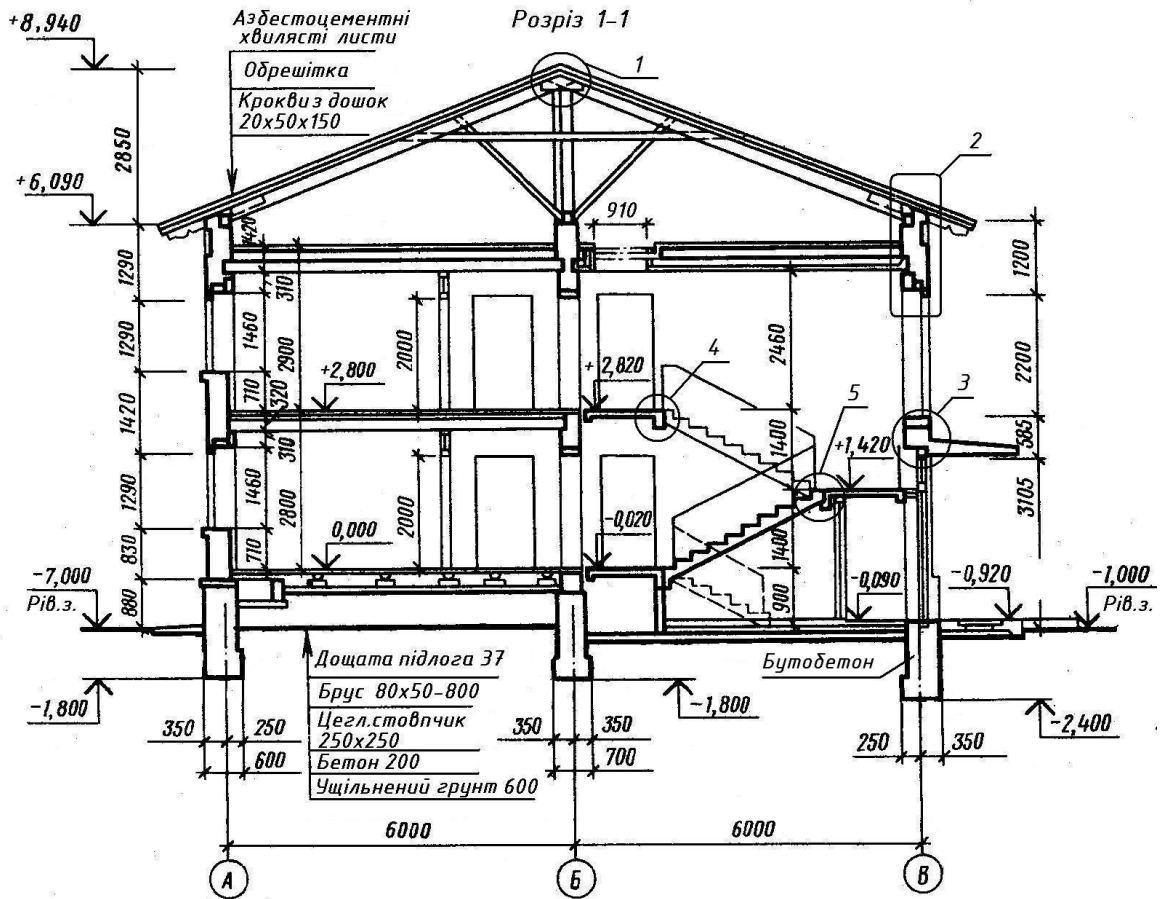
Конструктивний розріз будівлі: 1 – вузол даху; 2, 3 – вузли конструкції стін; 4, 5 – вузли сходової клітки
